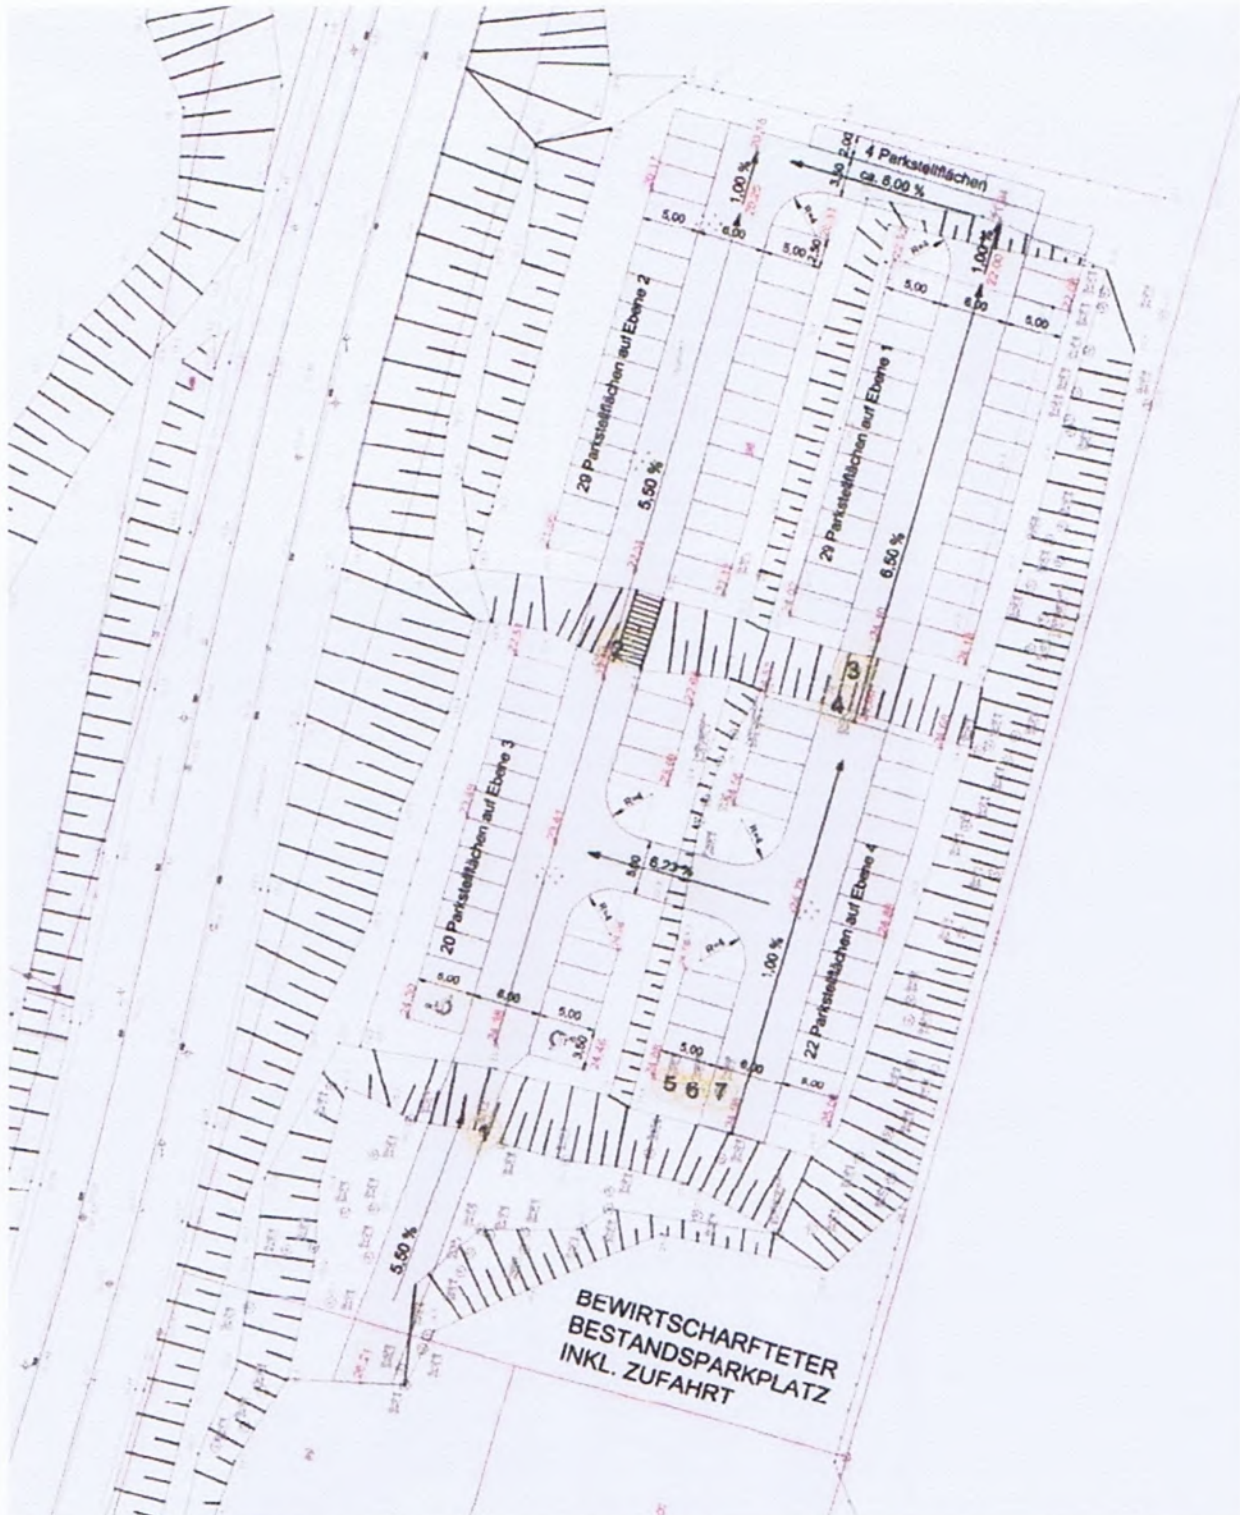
Parkplatzplanung 1. Ausbaustufe auf den nördlichen Ebenen; aib Bauplanung Rostock, Stand 12/2016
